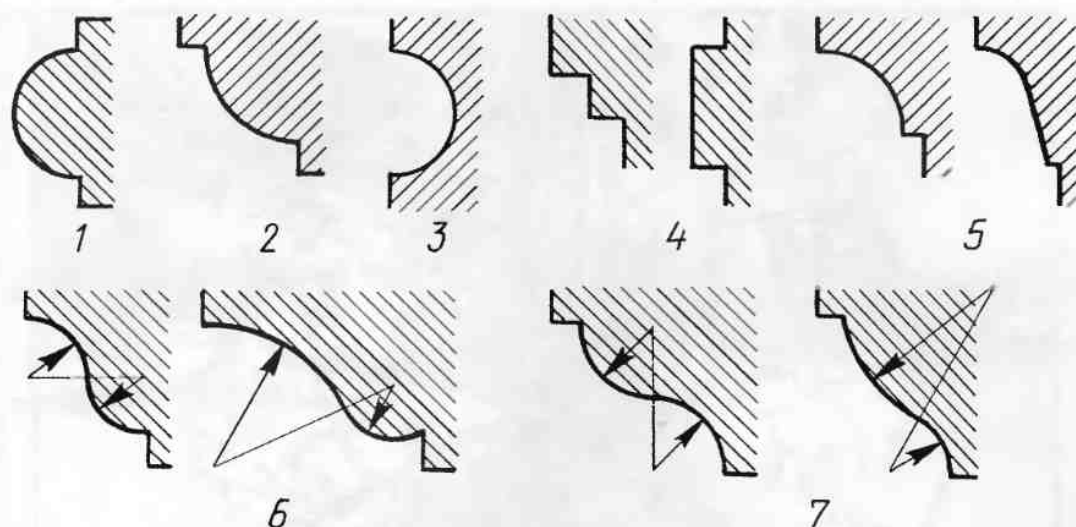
Профили окантовочных реек, карнизов, гладких багетных кантов и других линейно-вытянутых обрамлений: 1 — полувалик; 2 — четвертной валик; 3 — обратный полувалик (канавка); 4 — полочки; 5 — выкружка; 6 — гусек; 7 — каблучок
